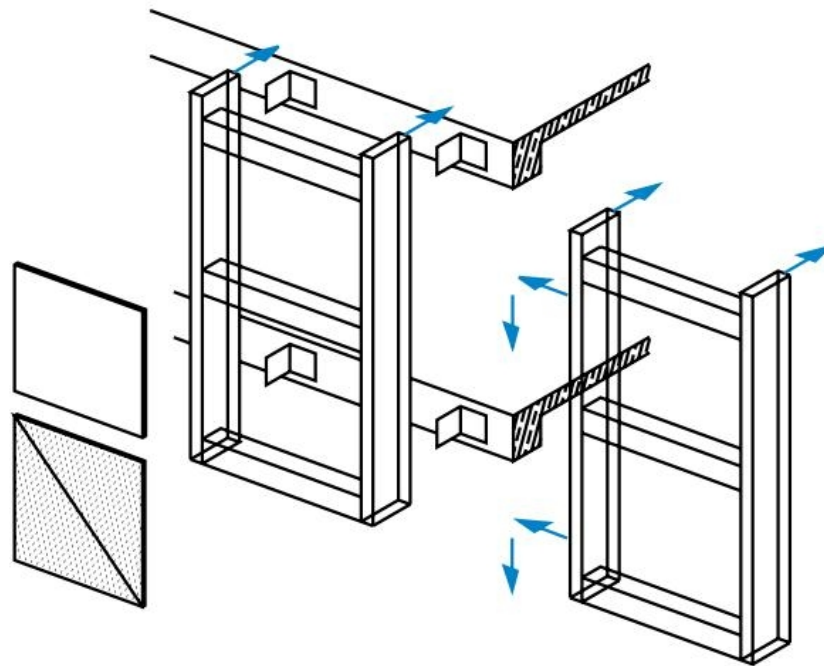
Схема монтажу вентильованих фасадів
